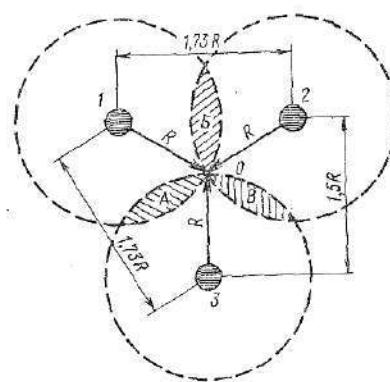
Схема размещения сосредоточенных зарядов при дроблении железобетонных конструкций:
